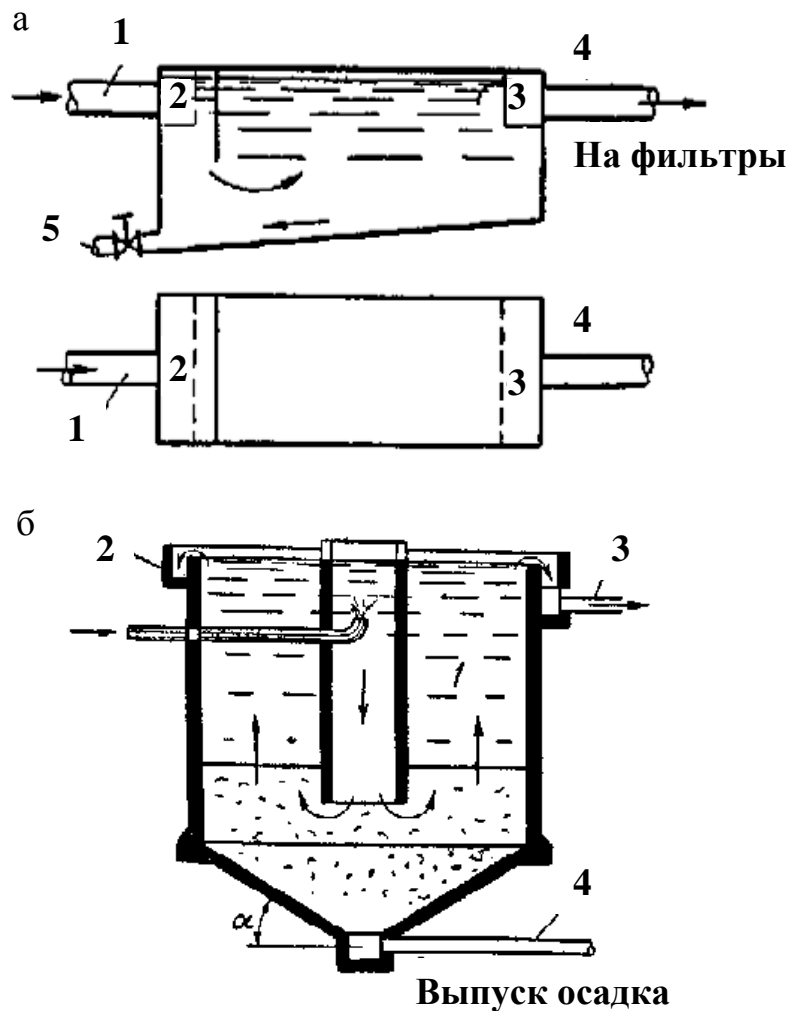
Схема отстойника: а – горизонтального; б – вертикального: 1, 4 – трубы; 2 – распределительный желоб; 3 – желоб
